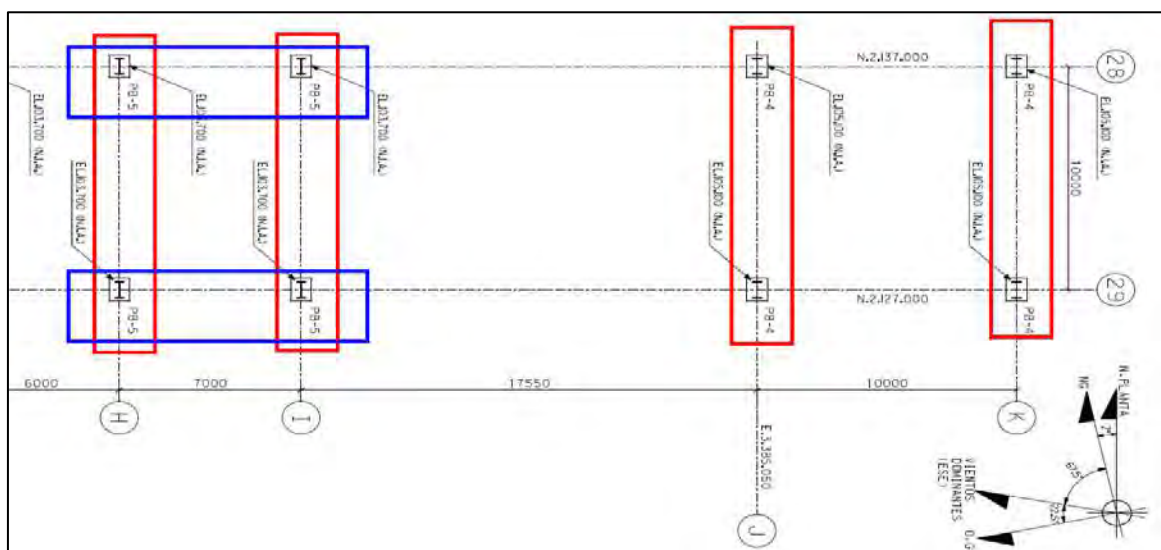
Vista de planta del *rack* BTCG, ejes H al K
